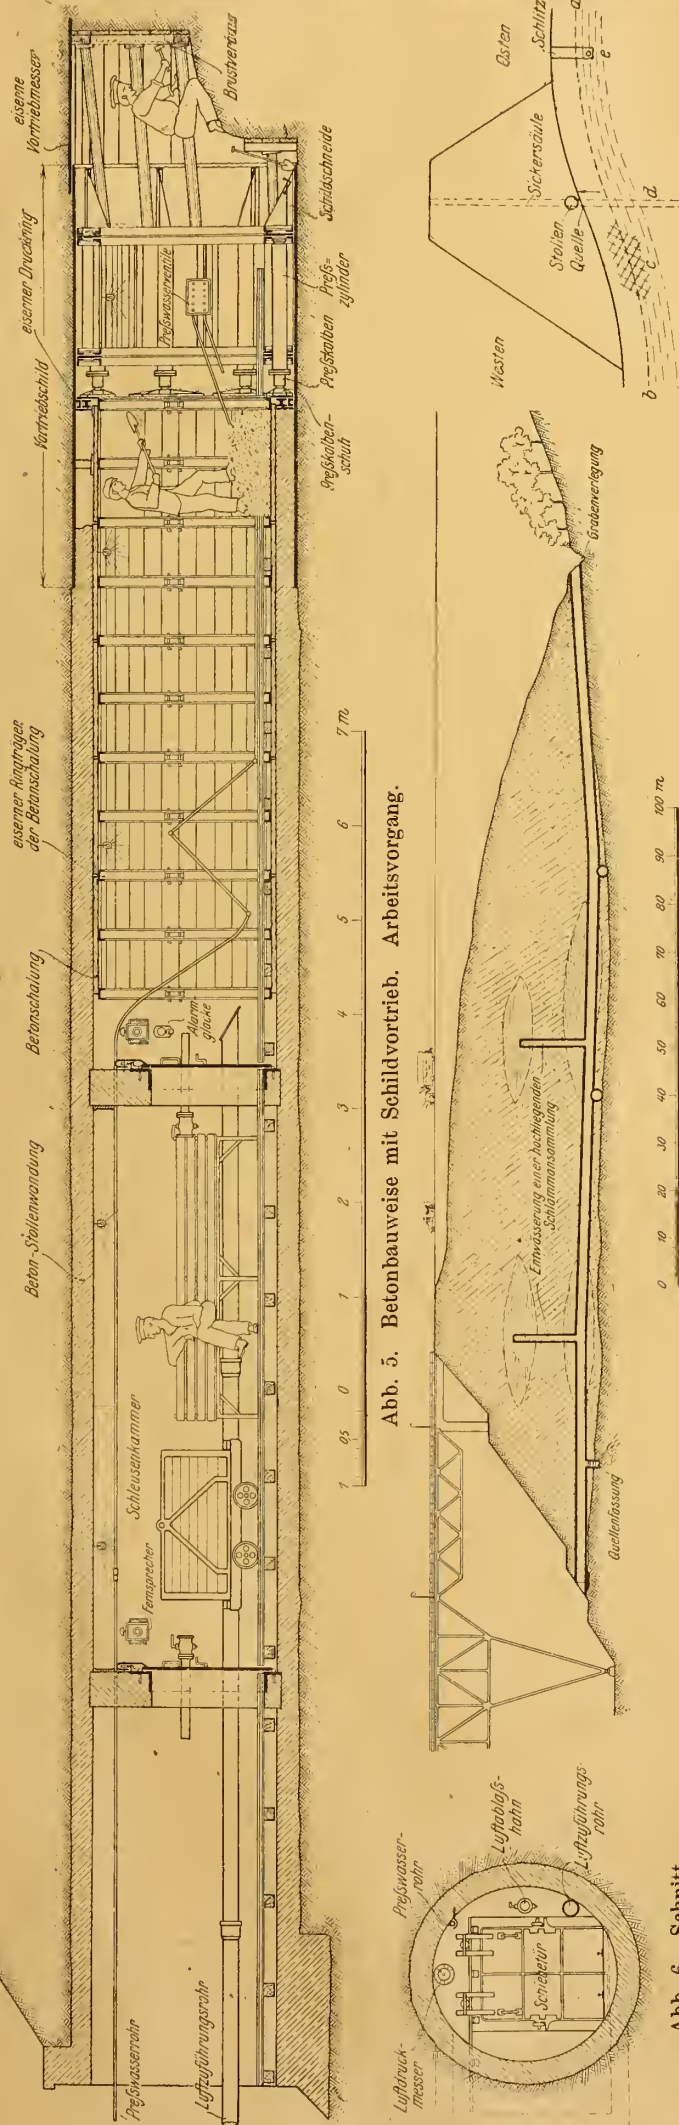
Betonbauweise mit Schildvortrieb. Arbeitsvorgang.
